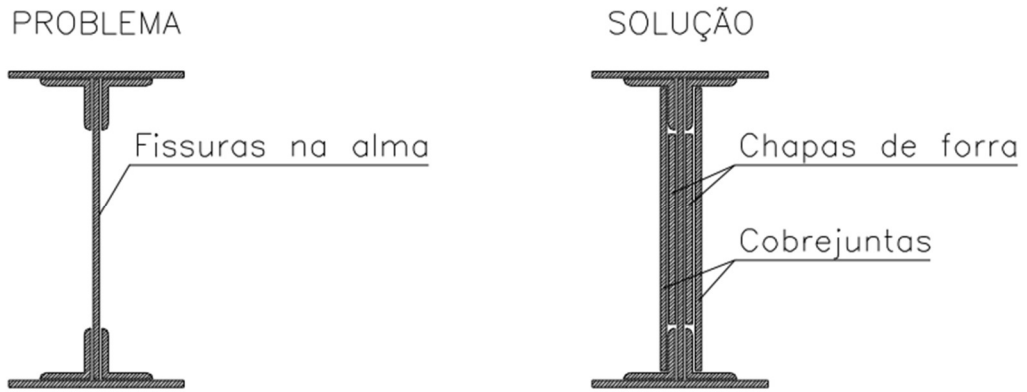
Exemplo de reforço em viga de ponte em estrutura metálica (Santos, N. E., 1998)
